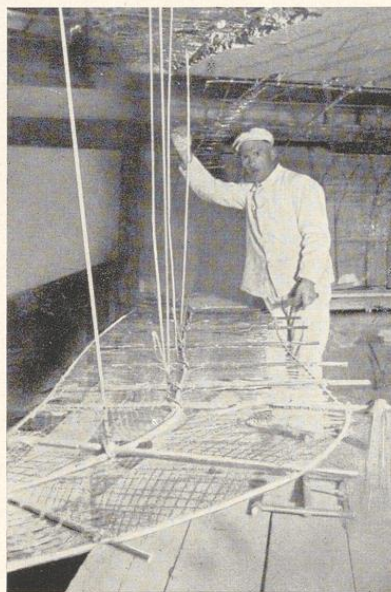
Eisenkonstruktion für einen Rabitzboden mit guter Aufhängung
